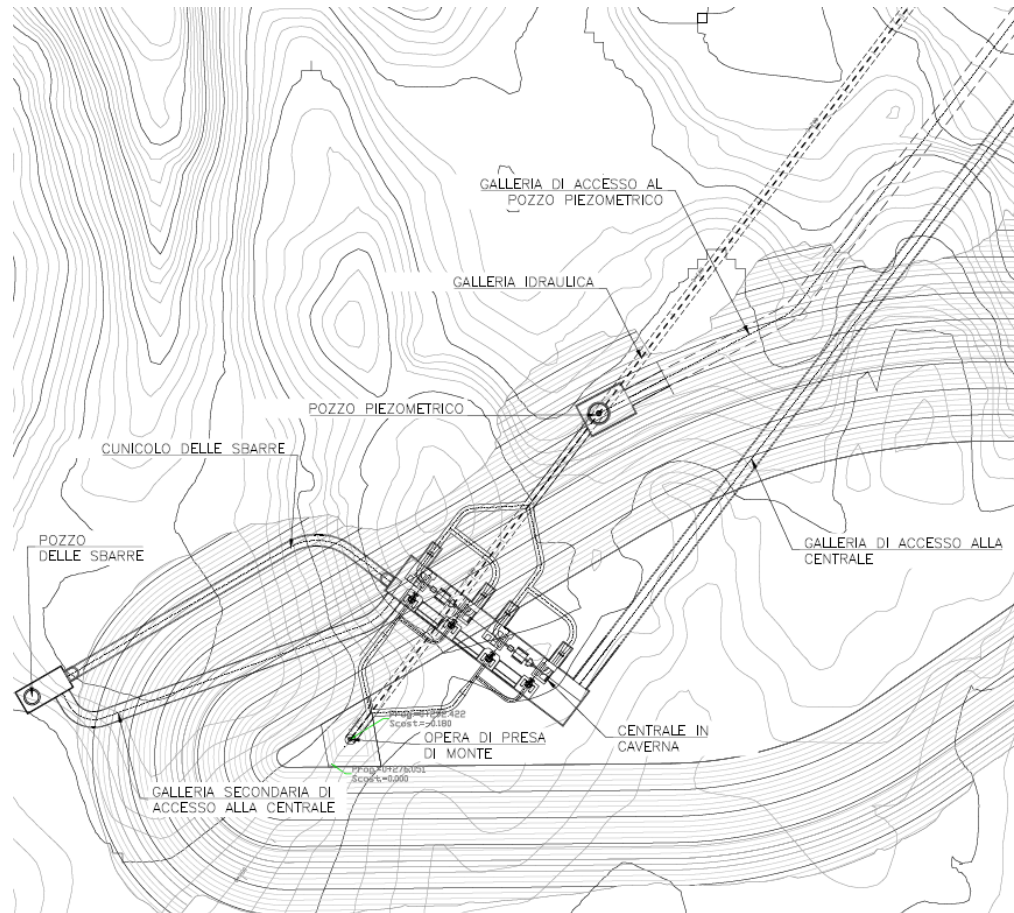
Planimetria della centrale in caverna e delle gallerie di accesso alla stessa
